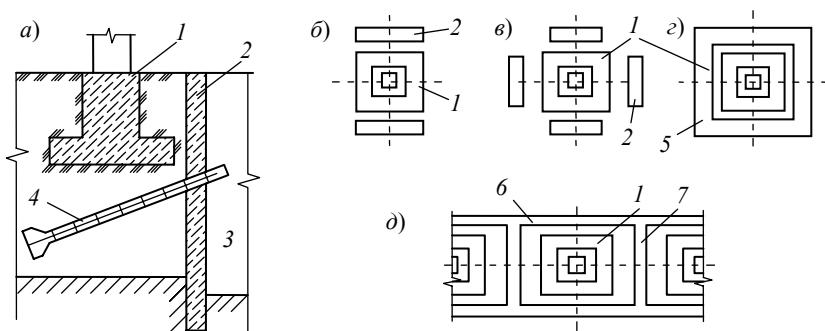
Схемы усиления фундаментов способом "стена в грунте":
